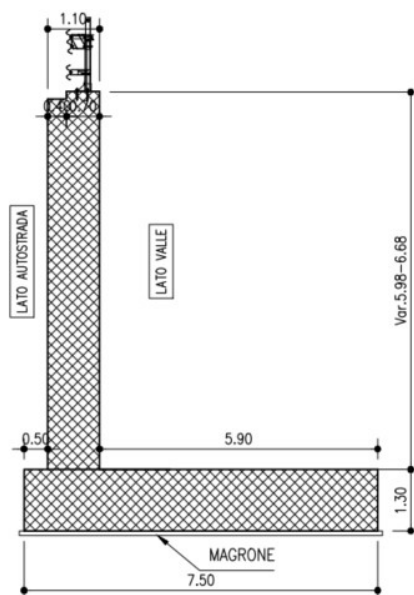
Sezione trasversale dei muri andatori carreggiata Sud
